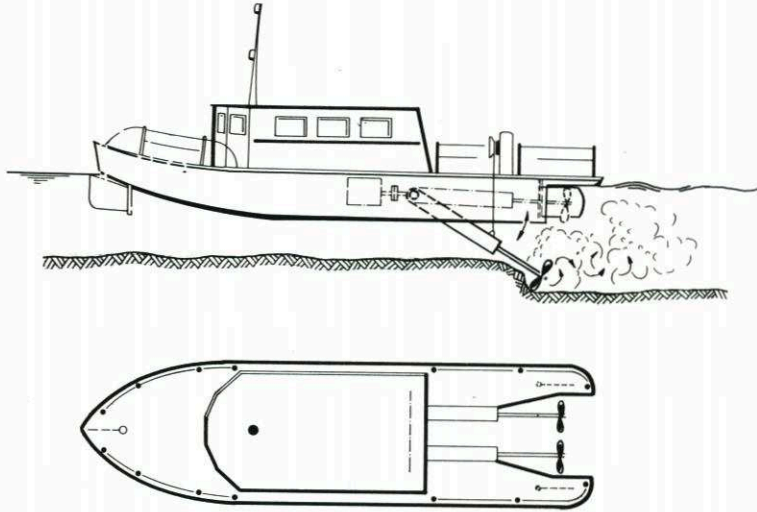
Stromräumboot in Seitenansicht und Draufsicht
